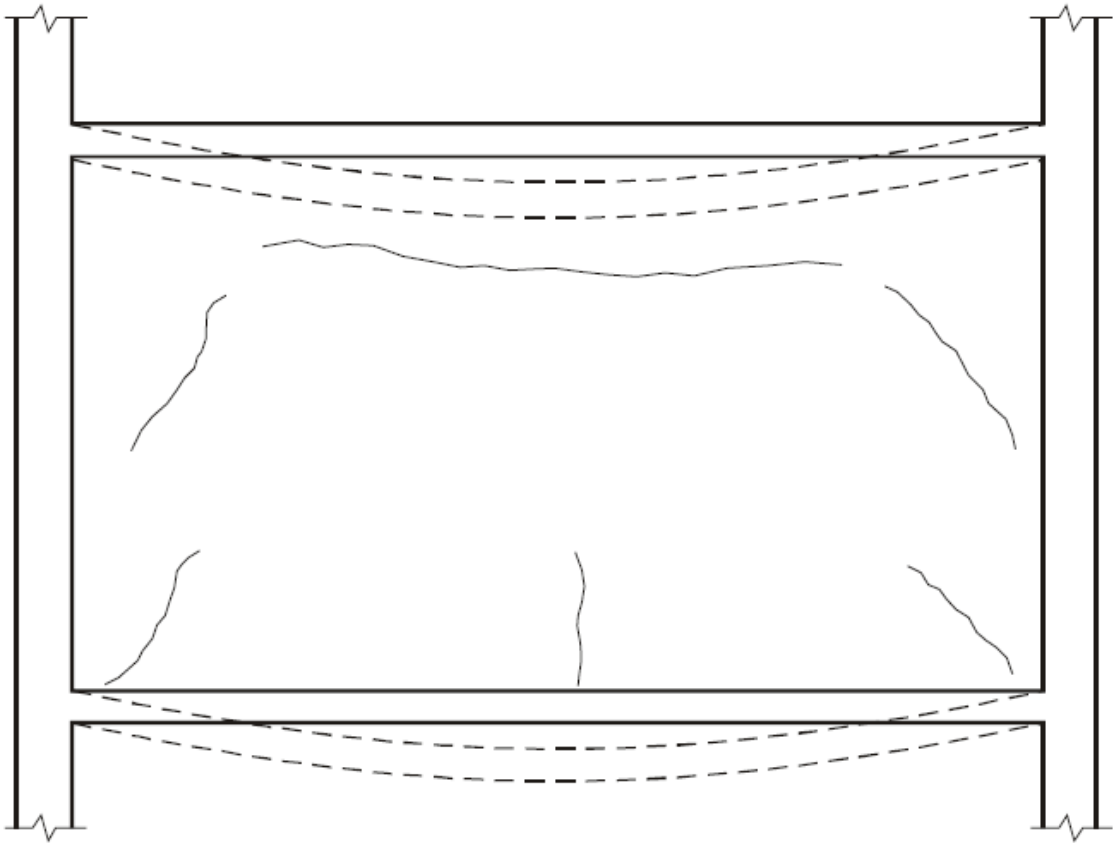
fissuras inclinadas em alvenaria devido à flecha excessiva em laje
